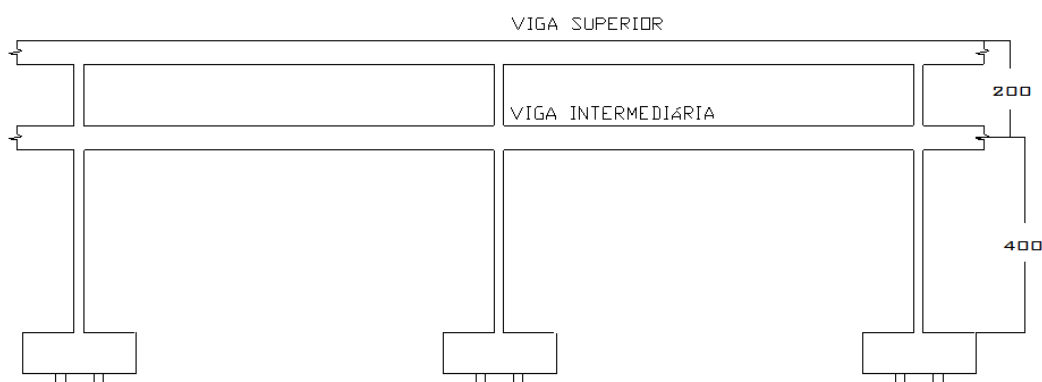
Vista da estrutura dos pórticos que constituem o shell²⁵ da estrutura
